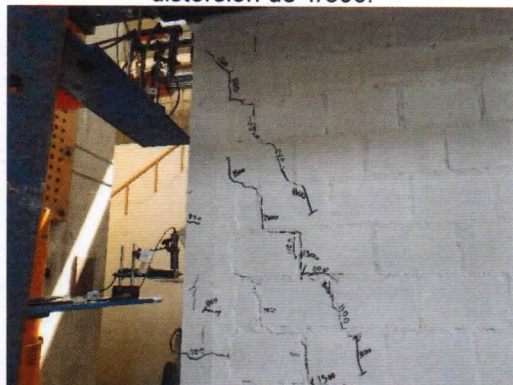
Continuación de grietas diagonales en el lado Oeste de la cara Sur para una distorsión de 1/800.
